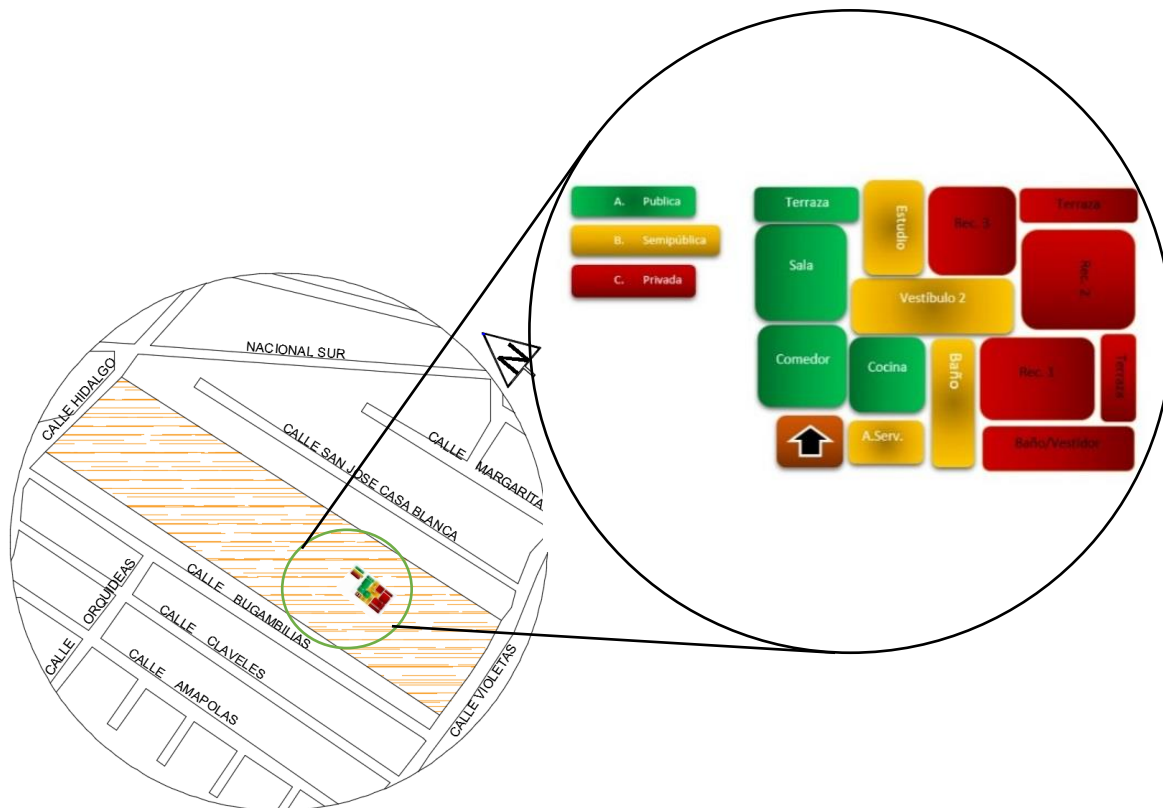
Propuesta de zonificación de la planta arquitectónica. Fuente: Elaboración en taller de tesis 2021.
